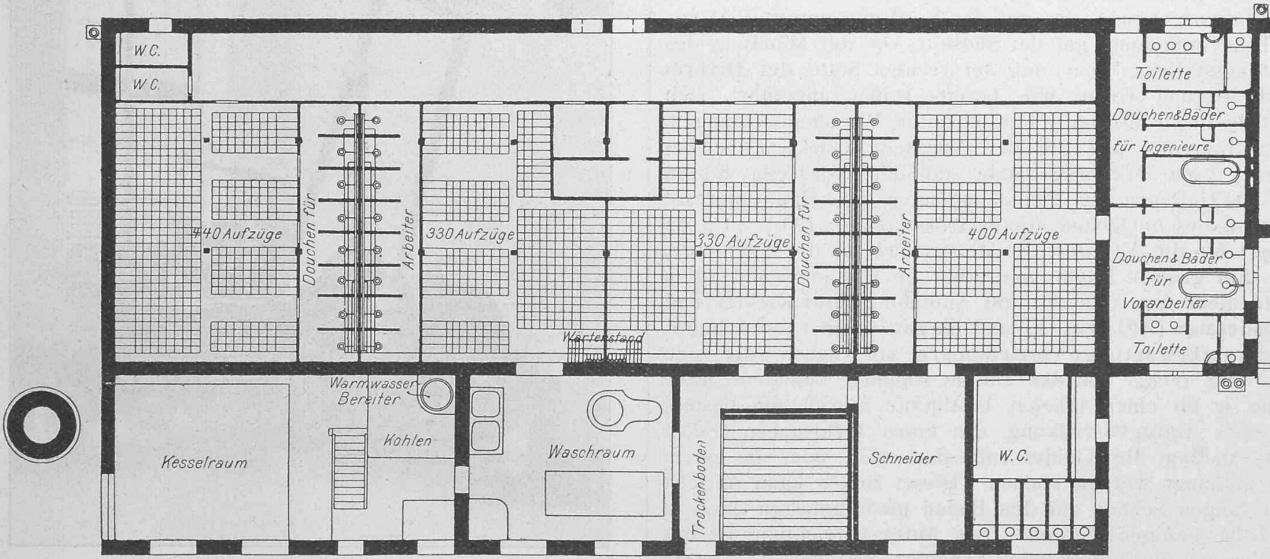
Stationsgebäude auf der Nordseite. — Grundriss der Baderäumlichkeiten und der Wascherei. — Massstab 1:250.
